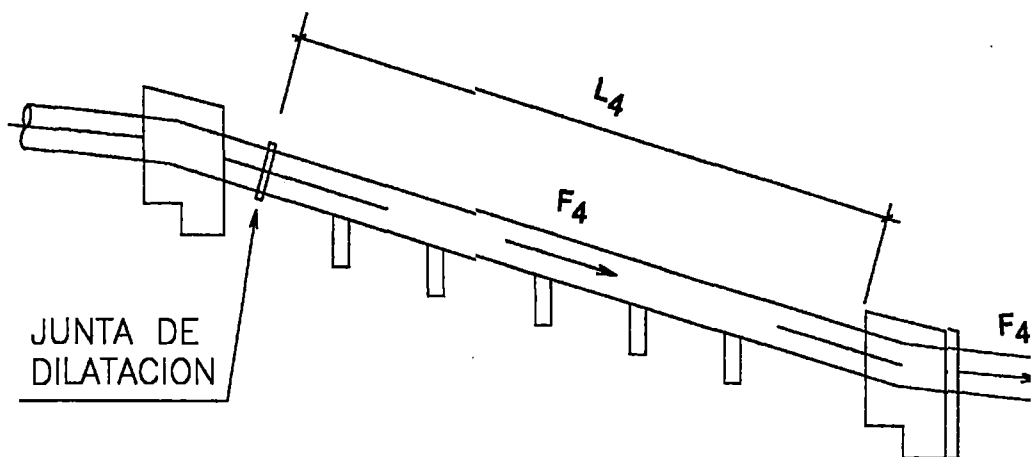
Fuerza F_4 para el diseño de los anclajes
